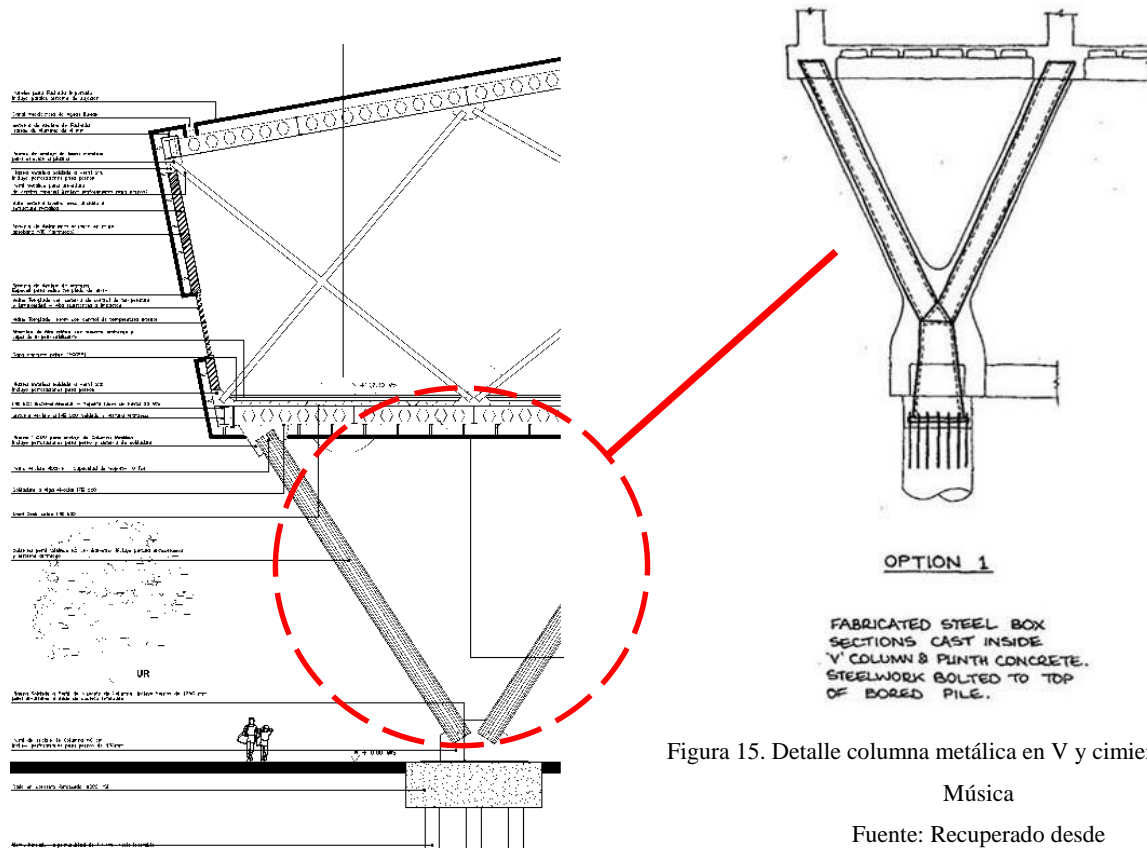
Detalle columna metálica en V y cimiento - Sala de la Música
